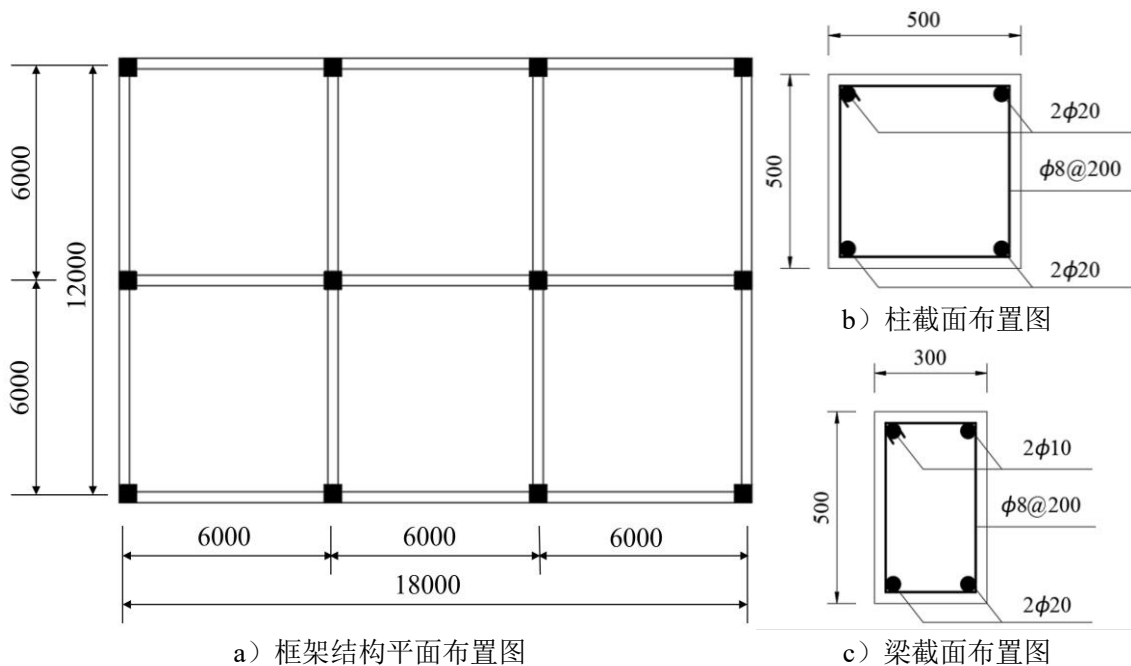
框架结构平面及梁柱截面布置（单位：mm）
